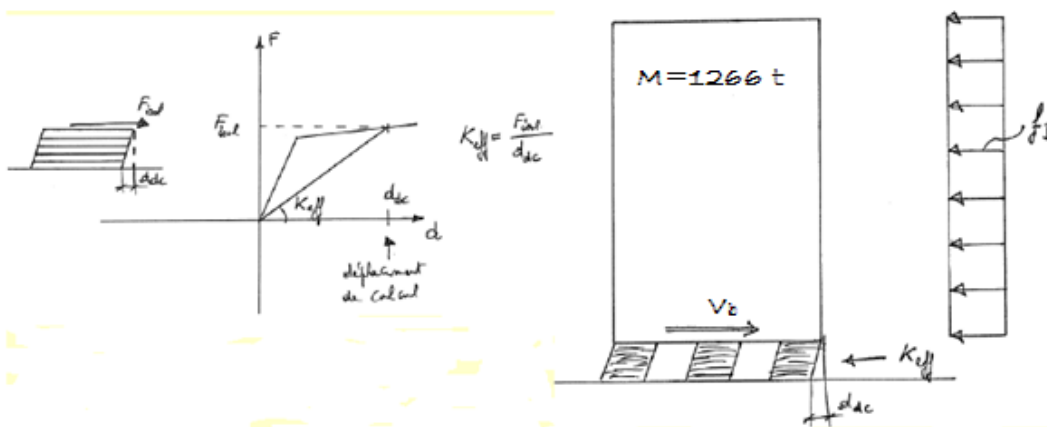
Exemple d'un bâtiment isolé à la base.
